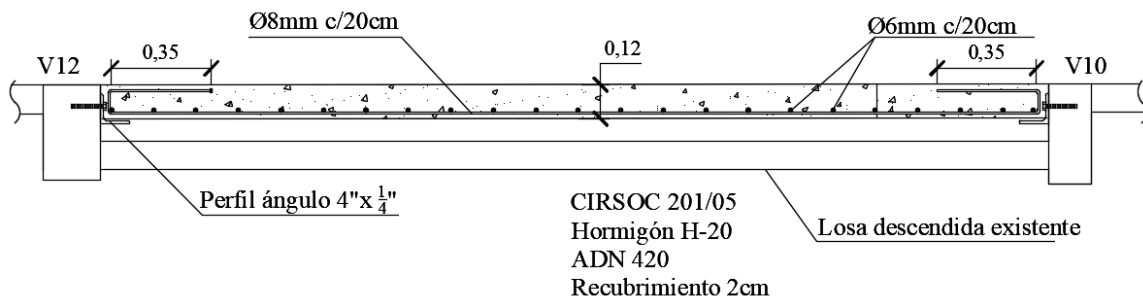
Esquema de corte A-A. Armadura losa nueva L2 baja.
